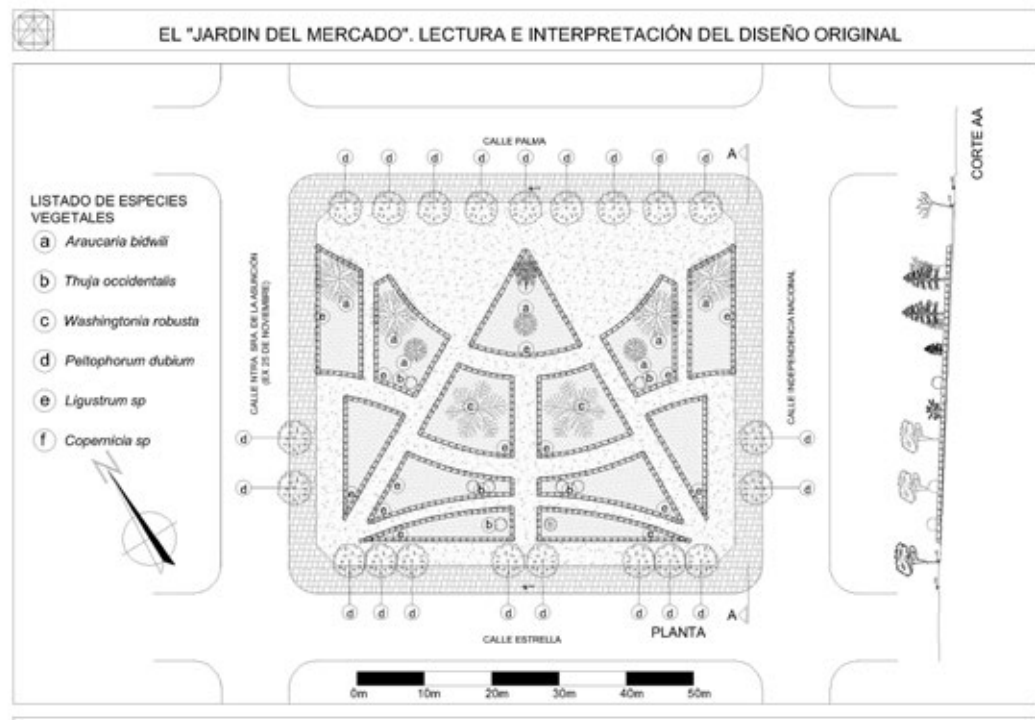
| Planta arquitectónica y corte esquemático del «Jardín del Mercado».
